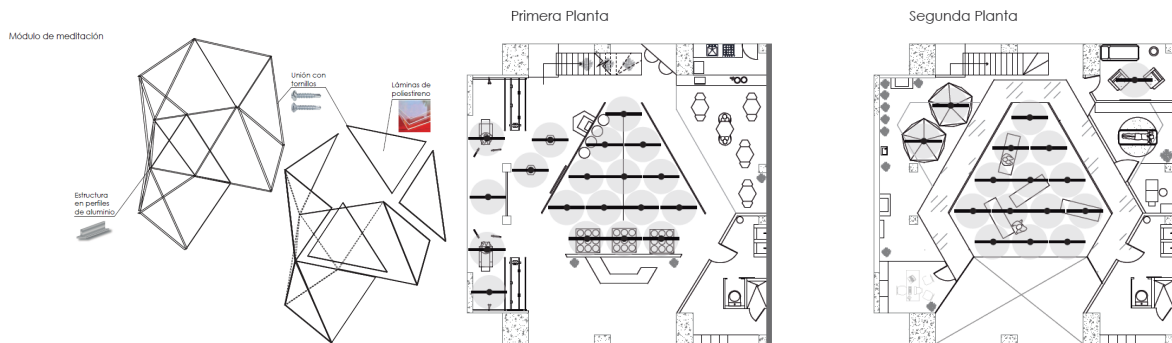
Detalle constructivo Módulo de meditación. Autoría propia. Pág: 94
